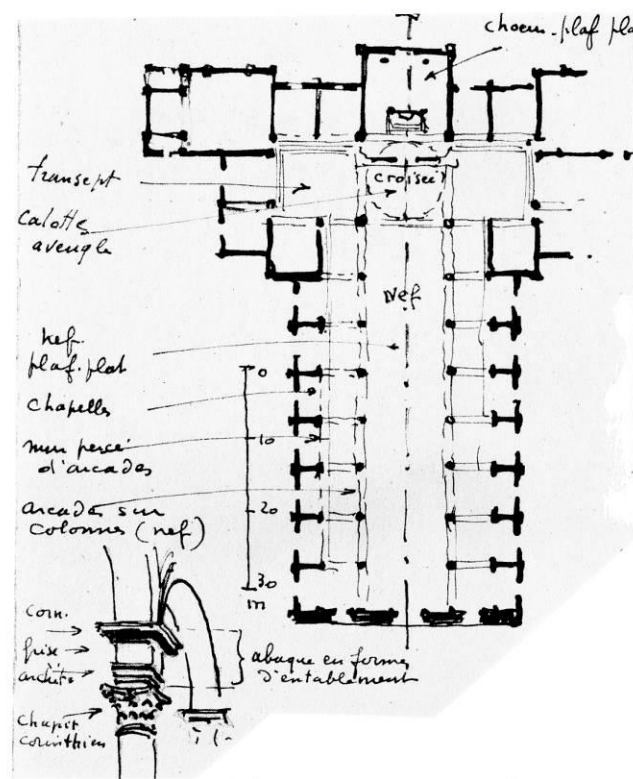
/100. Plan de l'Eglise San Lorenzo et détail d'une arcade, colonne et chapiteau.
